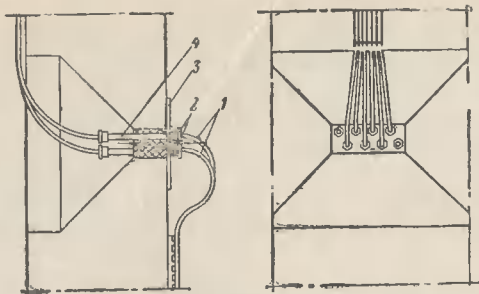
Проход кабелем сквозь стены из помещения с нормальной средой во взрывоопасное помещение в патрубках с сальниковым уплотнением.
